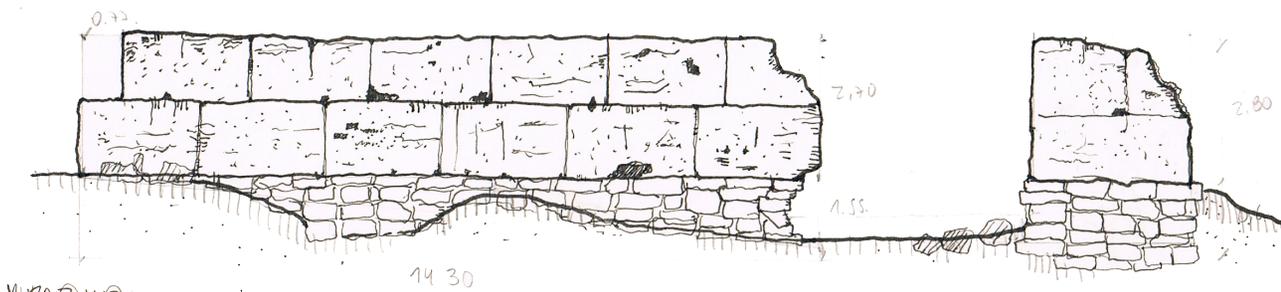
Levantamiento preliminar de la Mina Constanza.
